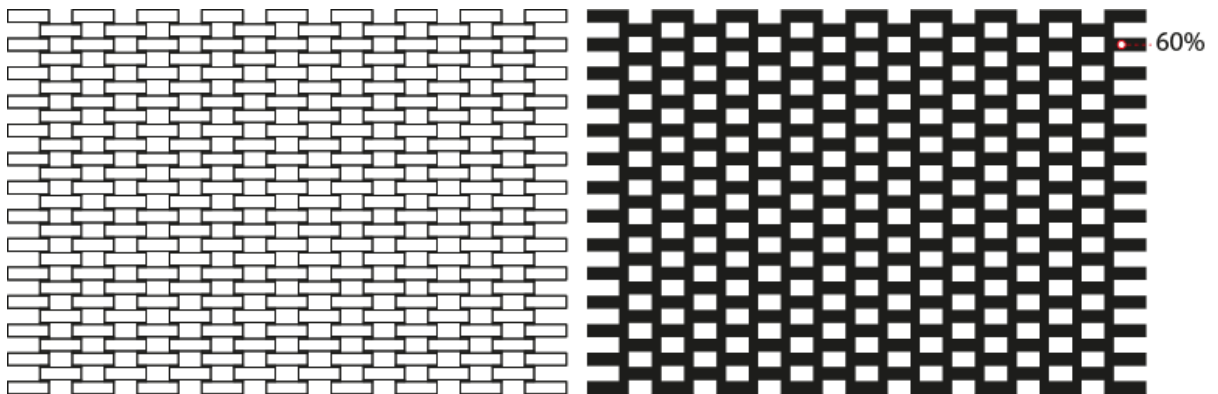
Sistema constructivo del elemento principal de la Casa estrecha de ladrillo.
